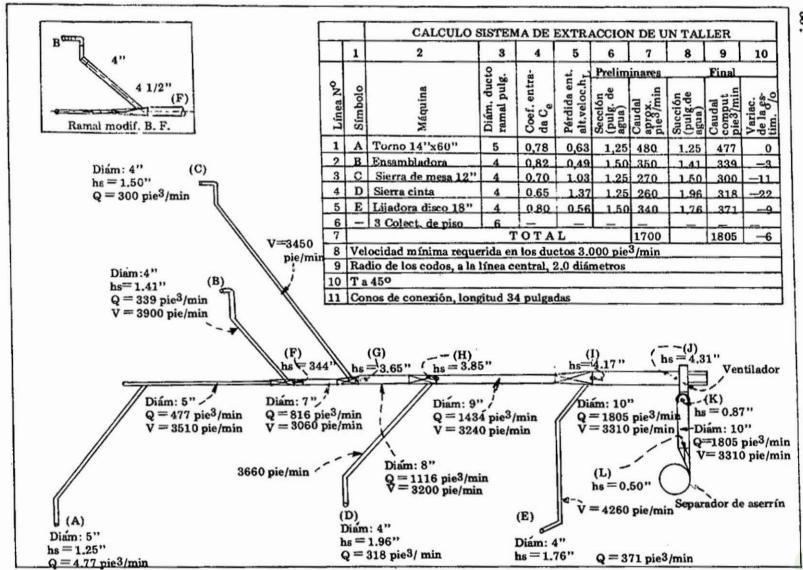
SISTEMA DE EXTRACCION PARA UNA PLANTA DE ELABORACION
